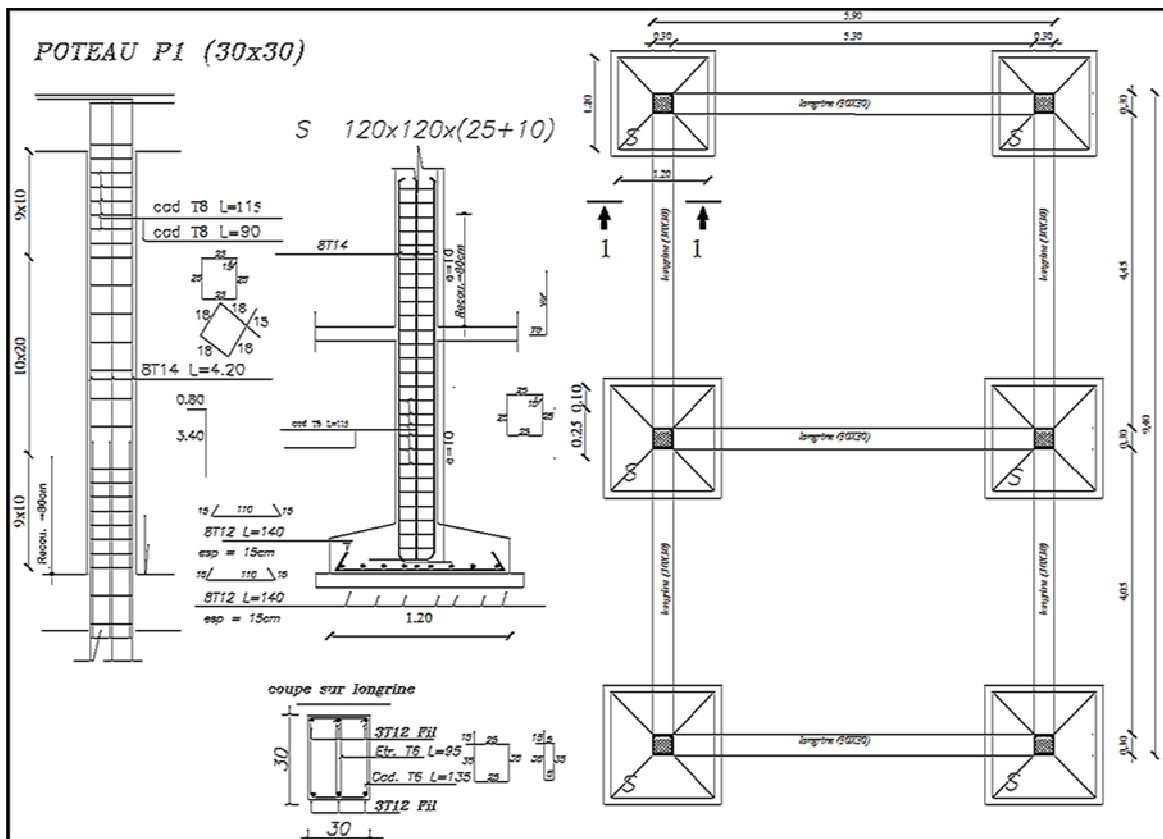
Plan de fondation et poteaux d'un poste livraison à comptage MT
